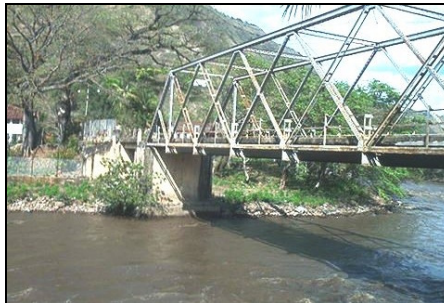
Detalle superestructura segunda parte. Puente Hernán Gómez Gómez.
